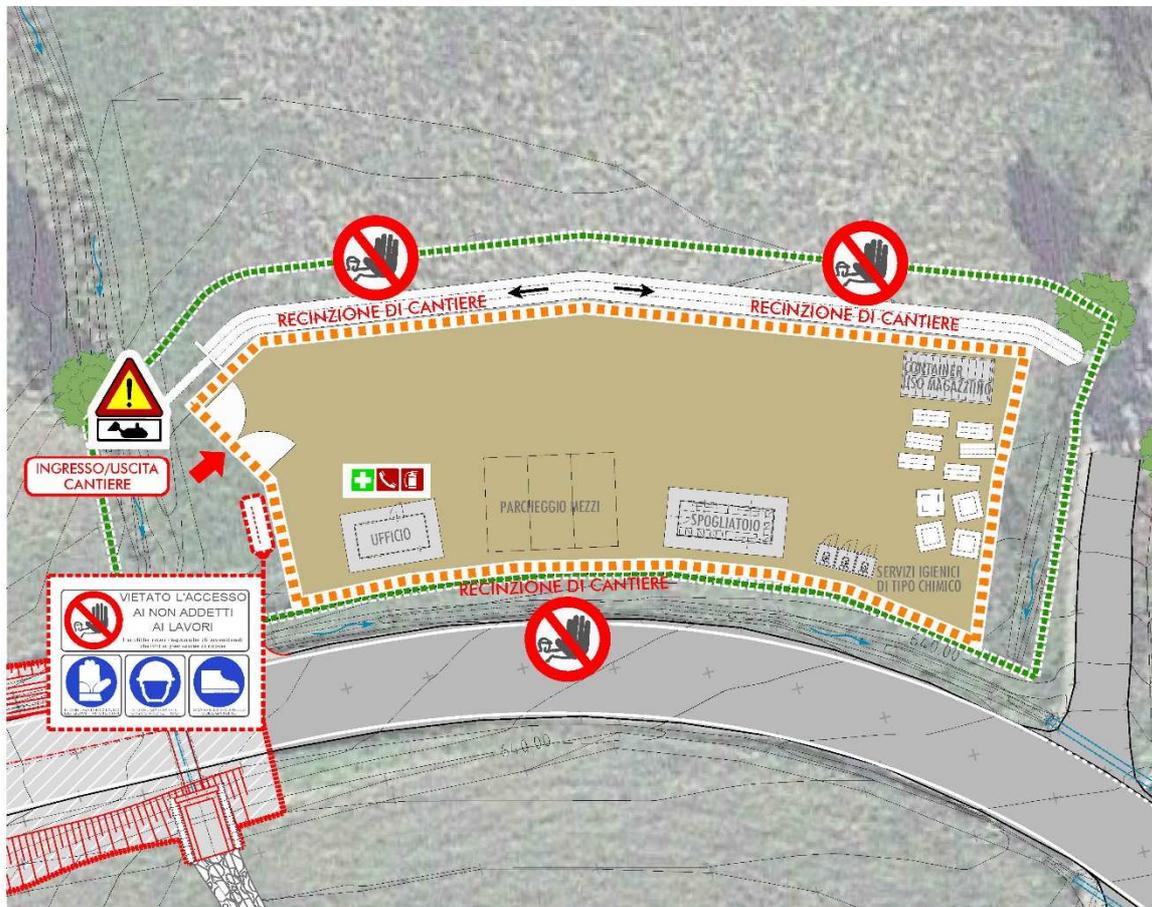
AREA DI CANTIERE FISSA
